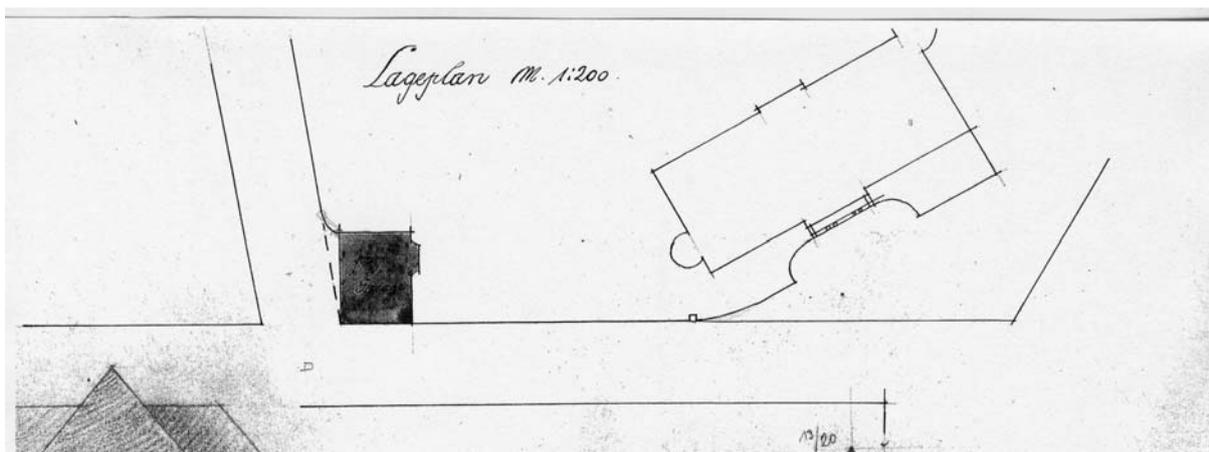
H. Plange, Lageplan des Landratsamtes Opladen mit dem projektierten Haus für den Chauffeur und den Garagen, 1913
